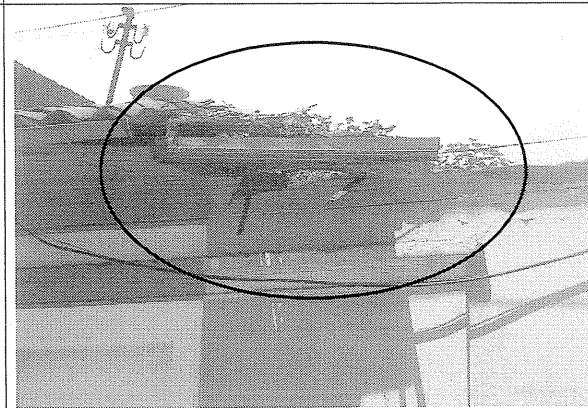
Elementos metálicos sueltos en la esquina superior del extremo norte del muro.
